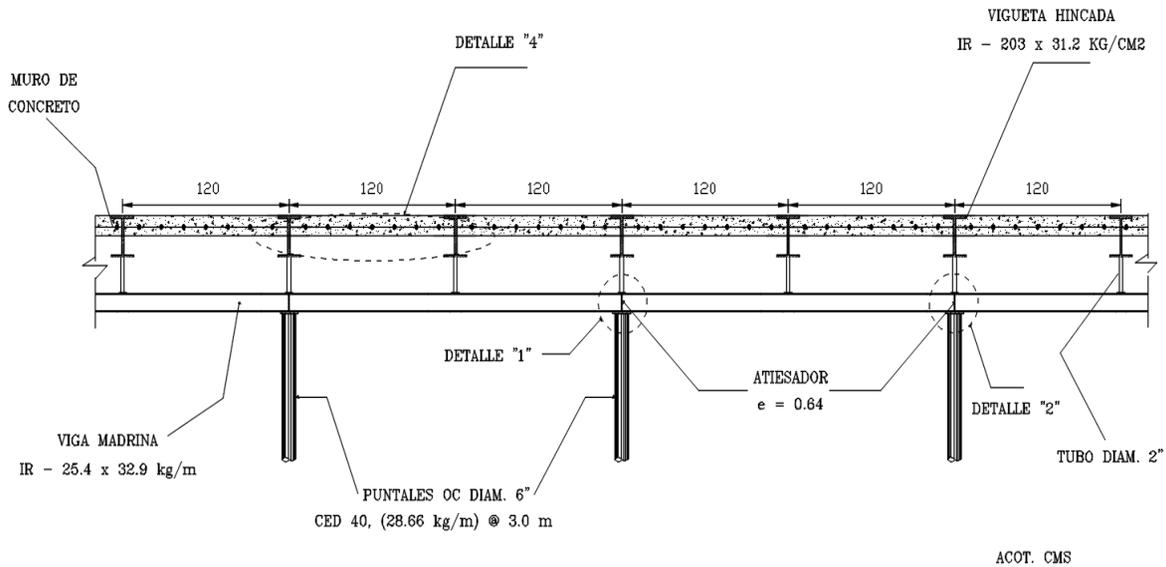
SISTEMA DE CONTENCIÓN.
